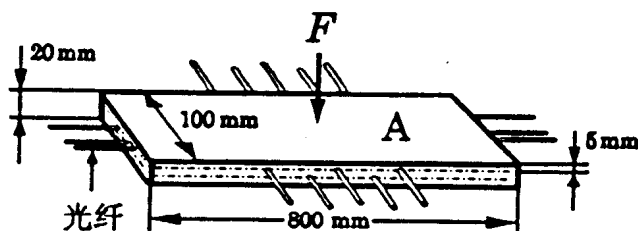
改进的埋入光纤传感阵列的混凝土构件示意图
